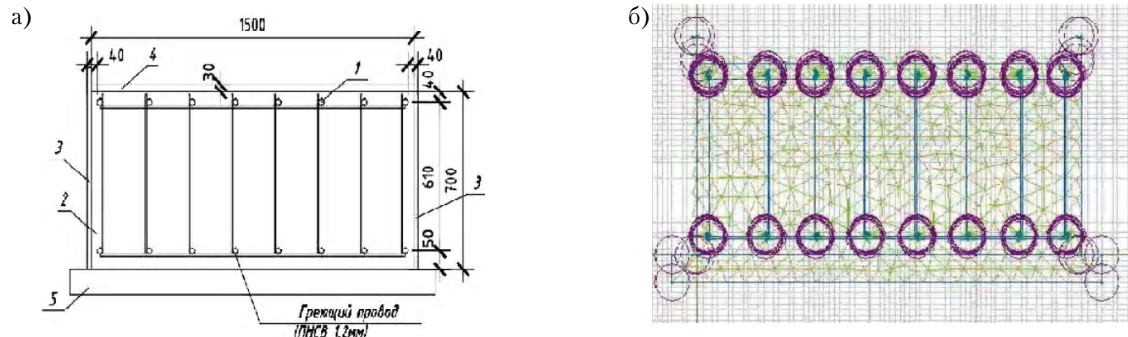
Монолитный ленточный фундамент: а) поперечное сечение моделируемого железобетонного ростверка; б) и расчетная модель с построением сетки конечных элементов.
